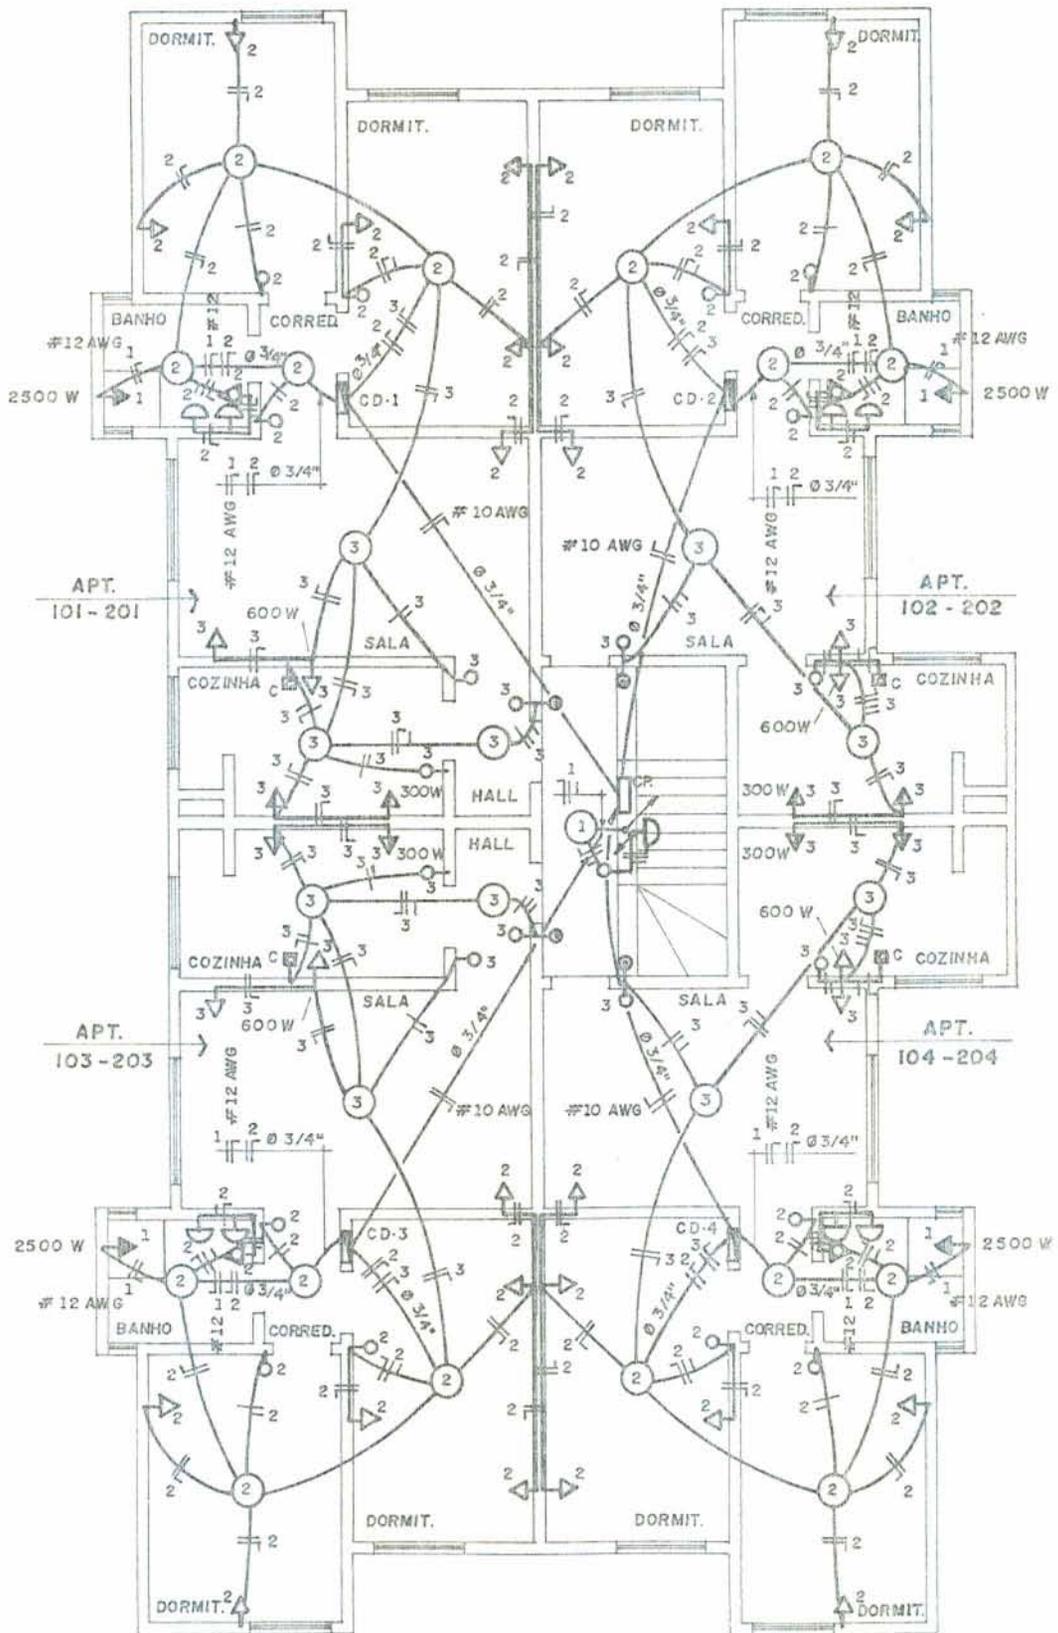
PLANTA DO PAVIMENTO TIPO - PROJETO DE INST. ELÉTRICA
